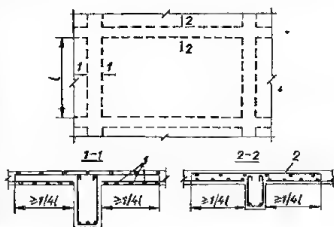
Армирование пропоровных участков плит, монолитно связанных с балками:
